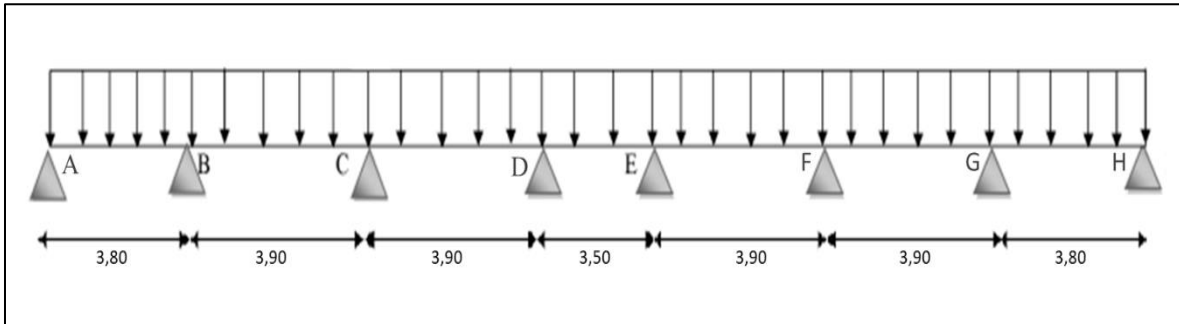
schéma statique de la poutrelle à 7 travées.
